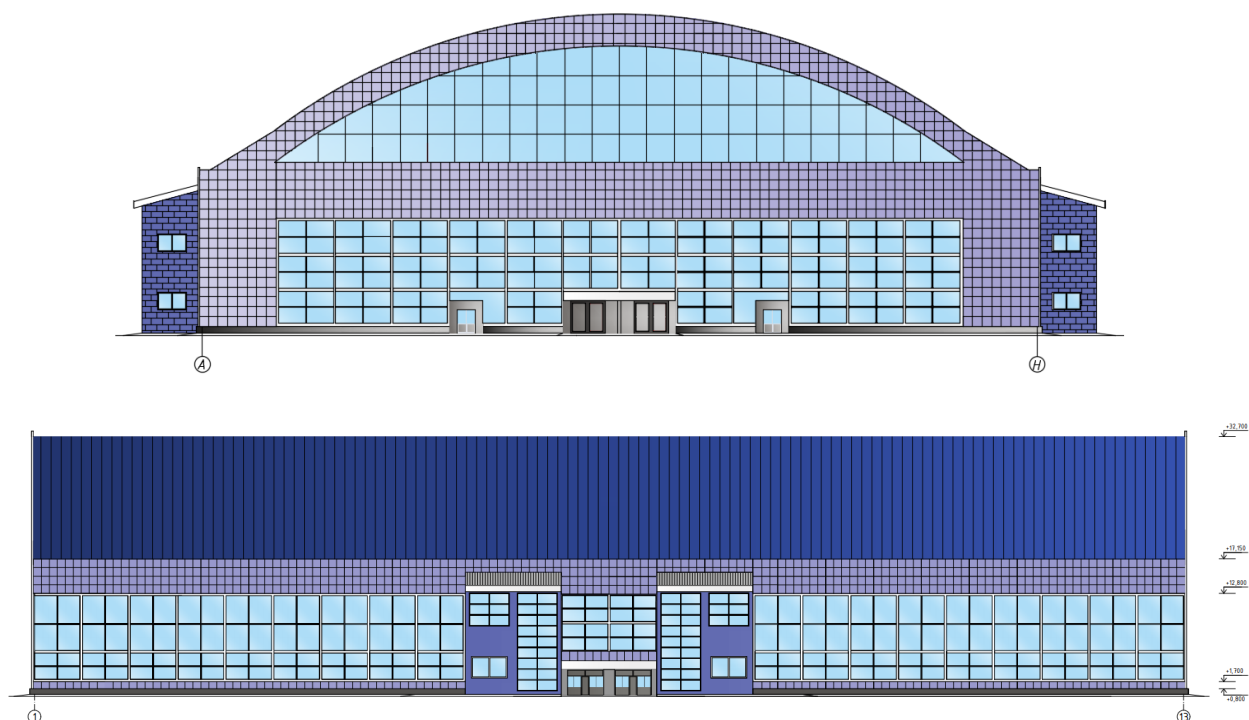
Фасады здания в осях А-Н и 1-13
